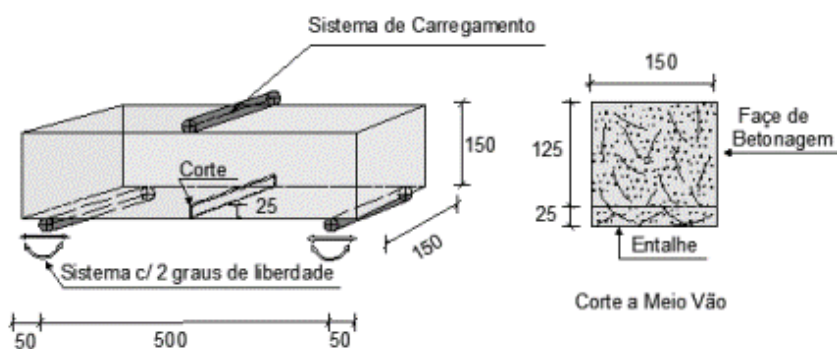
Ensaio à flexão na viga entalhada segundo EN 14651:2005
